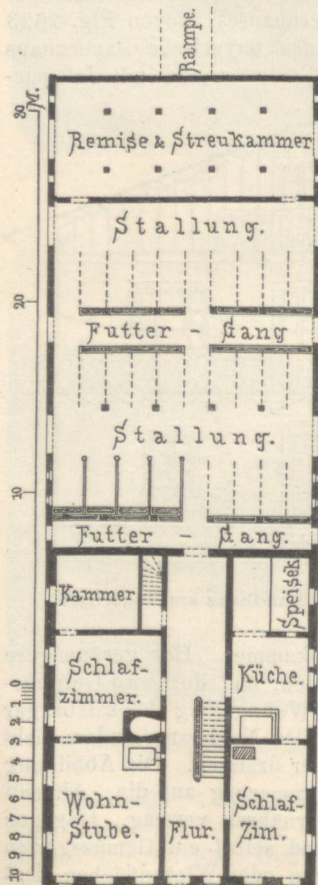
Erdgeschoss des Bauernhauses in Festenbach.
